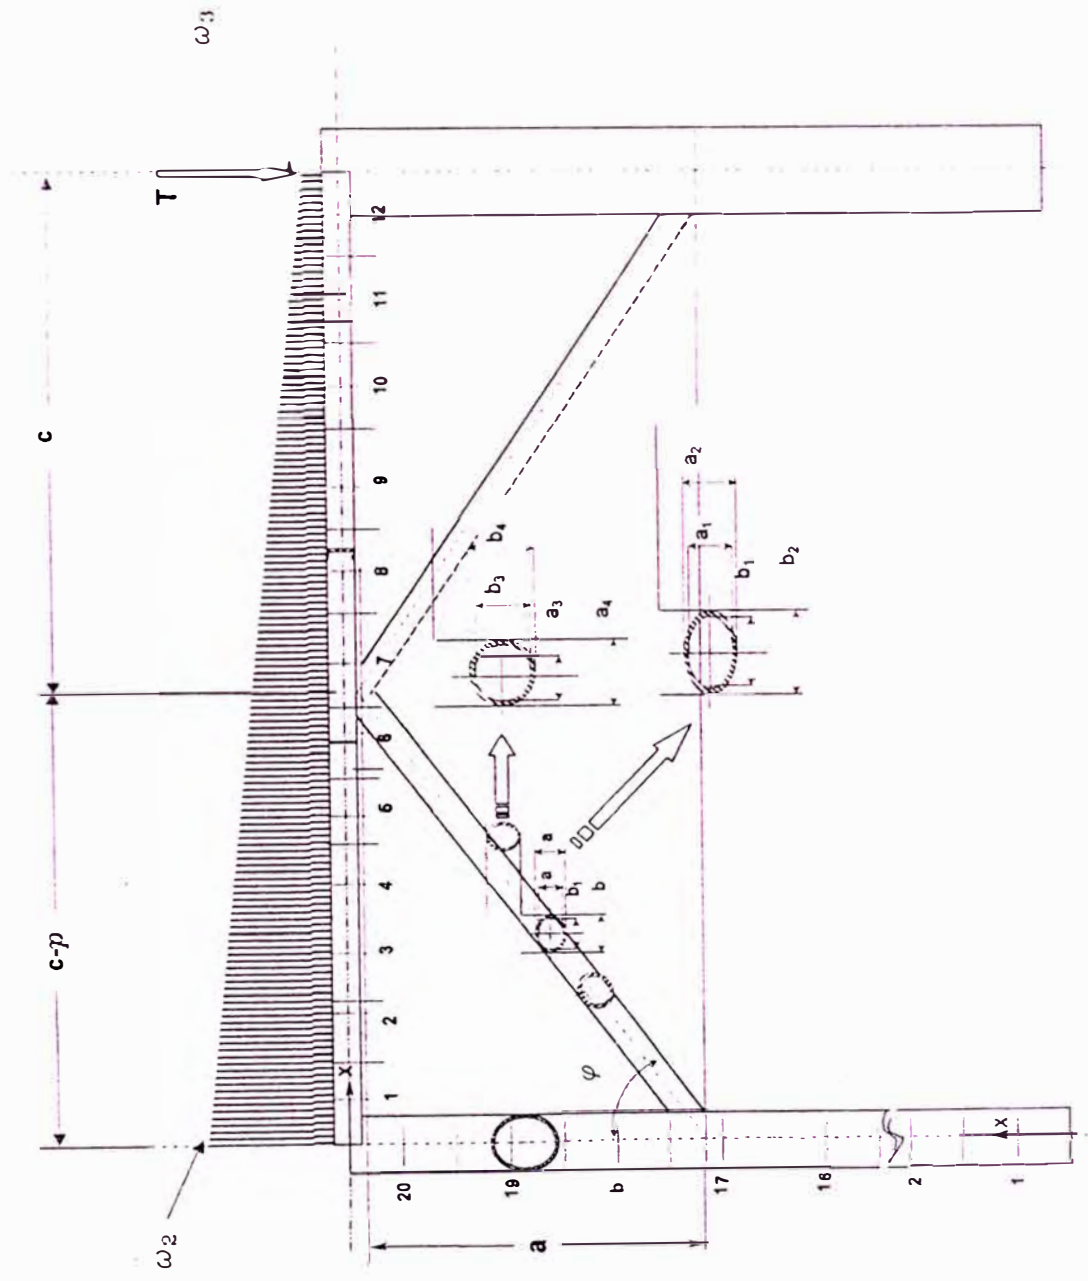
15 : DISTRIBUCION DE CARGAS EN VIGAS DE TECHO
